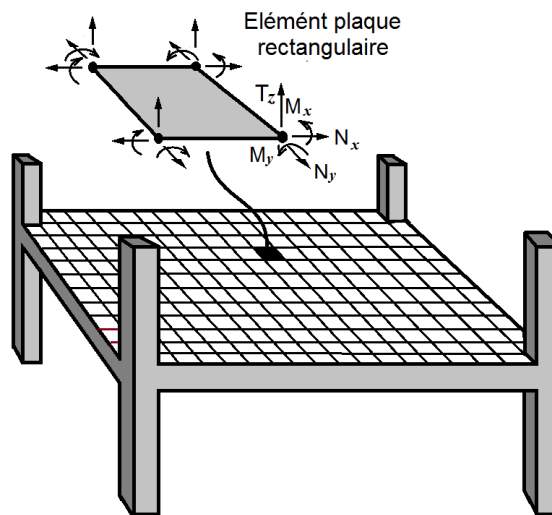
Modélisation d'une dalle pleine en béton par des éléments plaques rectangulaires
